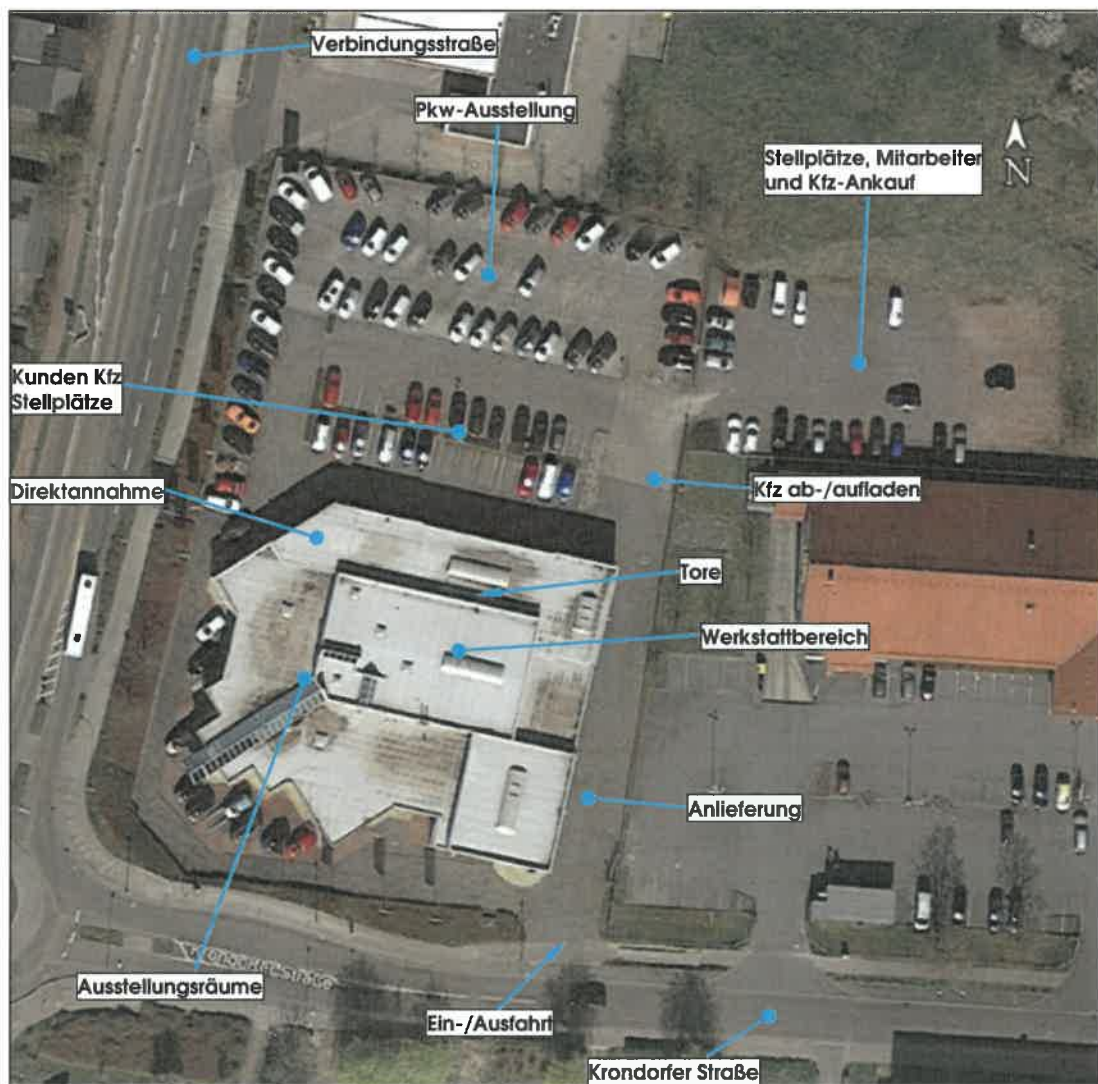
Lageplan, Autohaus, ohne Maßstab
